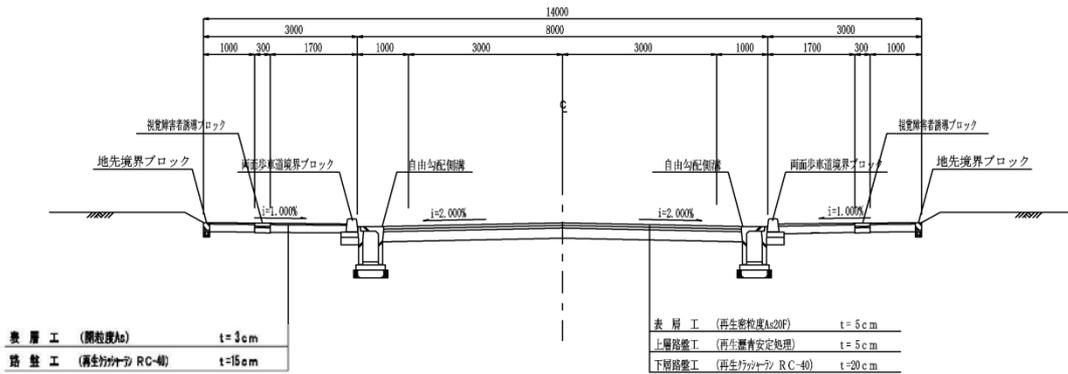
(2) 道路断面図(補助幹線道路: 14m 標準断面)
